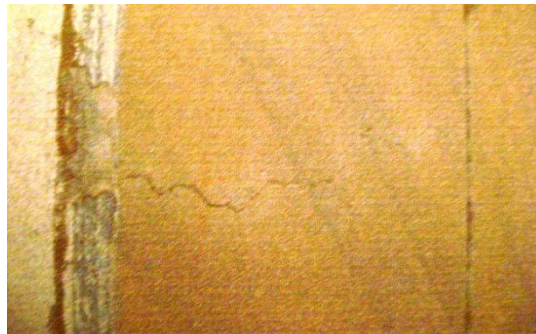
Fissure élevée (bout bétonné N°19)
